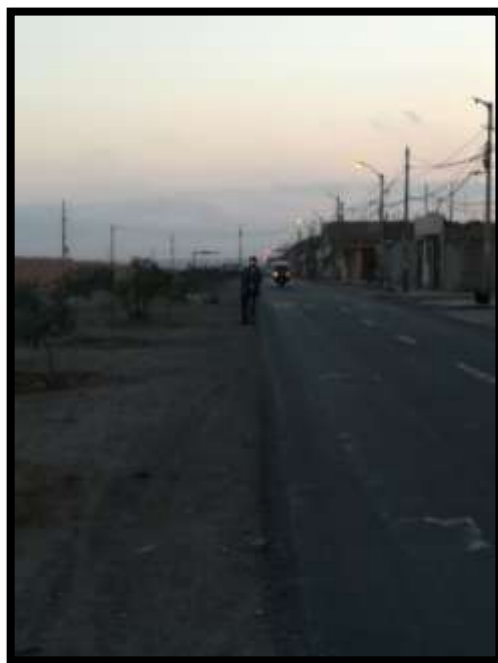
“Levantamiento de datos en la Avenida Perimetral 02”
